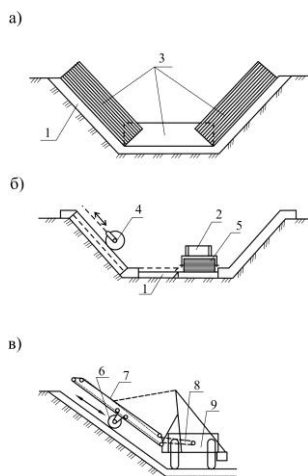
Уплотнение бетонных смесей при бетонировании канала
